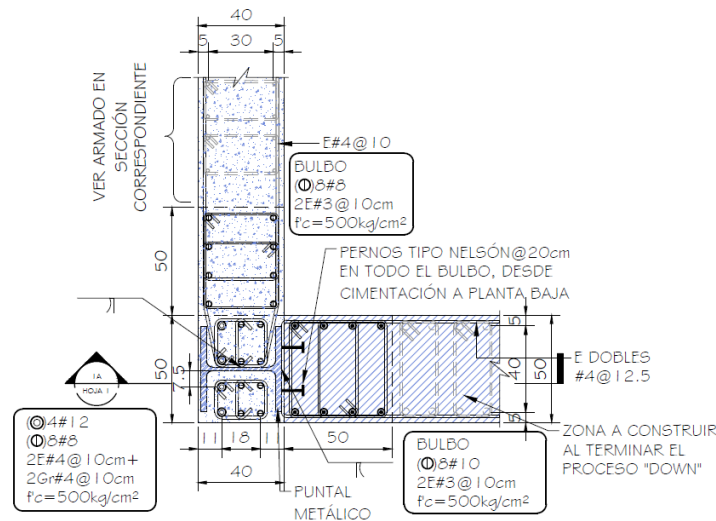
Sección de bulbo de muro de rigidez con perfil pre-cimentado embebido
